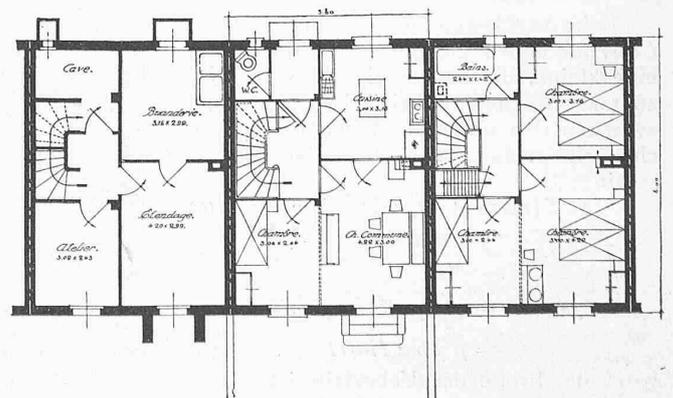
Einfamilien-Reihenhaus, Typ A. — Grundrisse 1 : 200.
